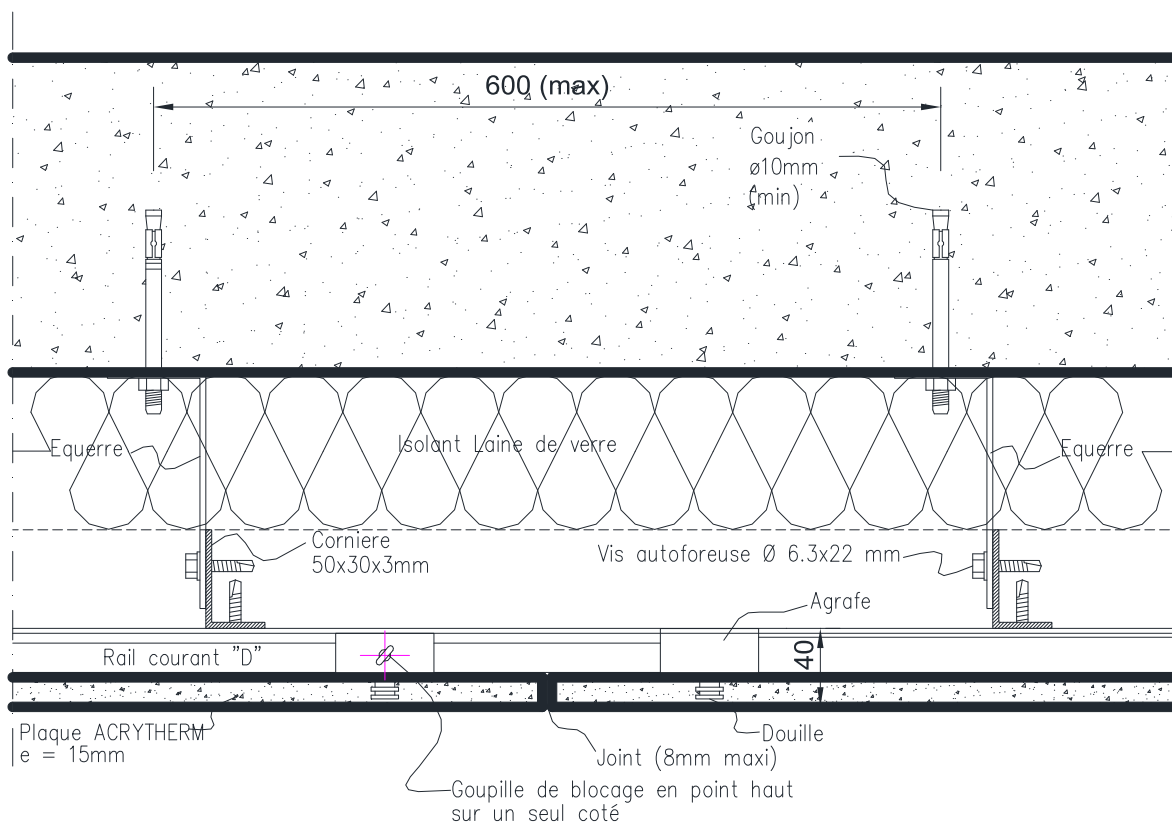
Coupe horizontale sur joint vertical avec douille femelle
